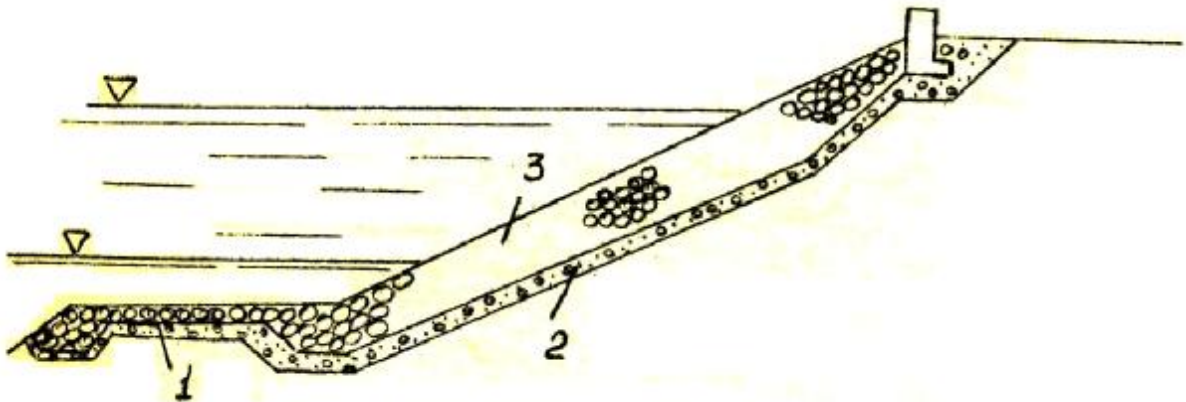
Схема конструкції кріплення укосу з кам'яного насипу: 1 – полегшене кріплення; 2 – підготовка одношарова; 3 – основне покриття з каменю
